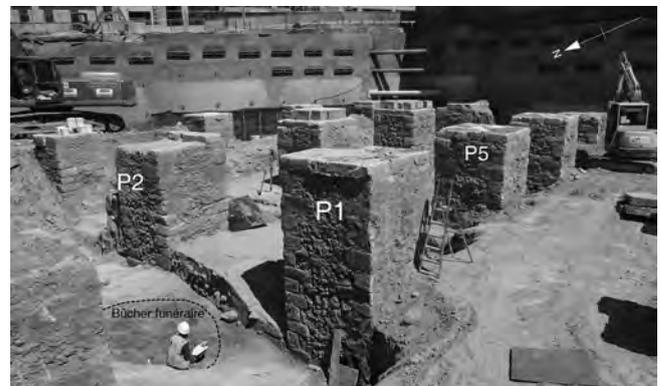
MARSEILLE, 104 boulevard de Paris. Construction des fondations enterrées des piliers P1, P2 et P5 et bûcher funéraire (M. Touma / Chronoterre Archéologie).
